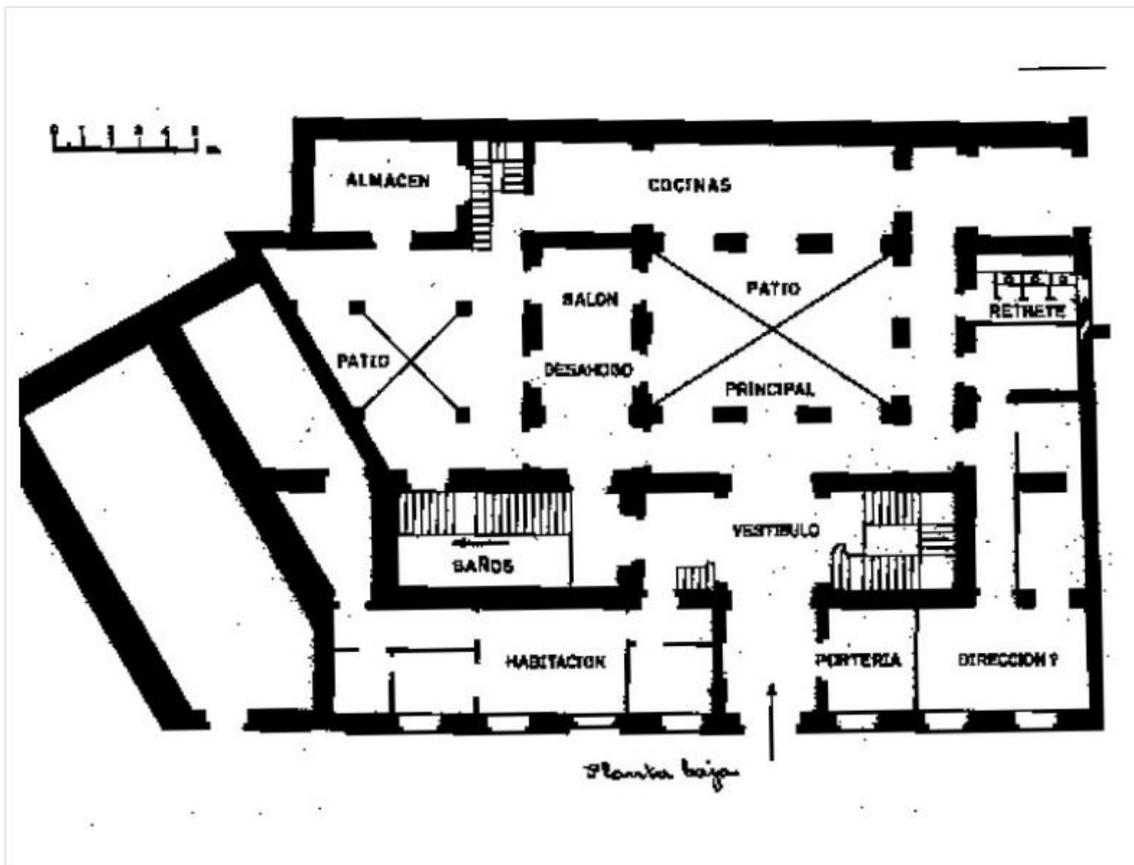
Plano de la planta baja del Hotel Balneario. Fuente: BAÑOS SERRANO, J., CHIMILLAS LOPEZ, A., RAMIREZ AGUILA, J.A., 1997: “El complejo termal de Murcia. II campaña de excavaciones (1991-92)”, *Memorias de Arqueología*, 6, p. 182.
